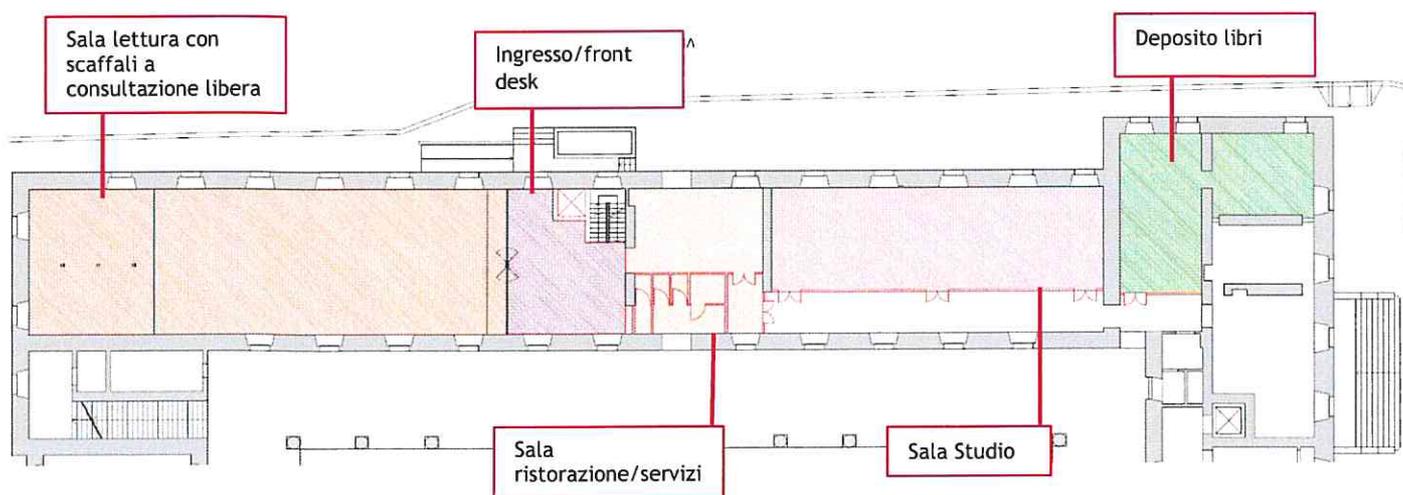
\_Planimetrie funzionali della soluzione progettuale del Piano Terra;
